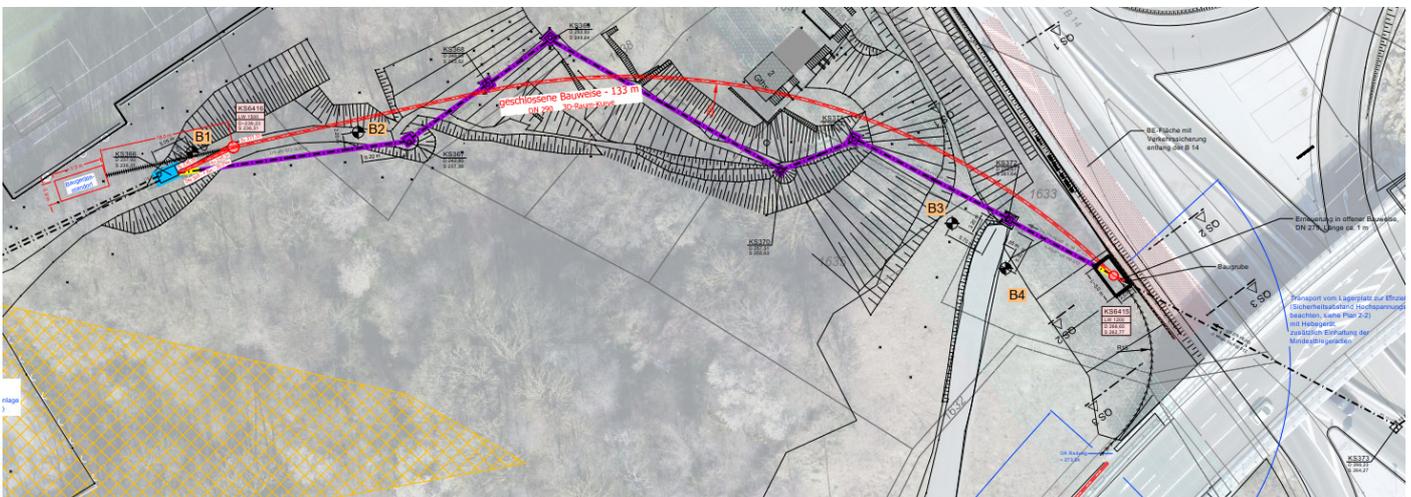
Lageplanausschnitt HDD-Bohrtrasse
